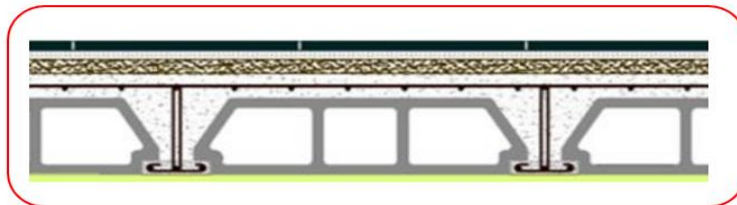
Coupe d'un plancher terrasse accessible à corps creux
